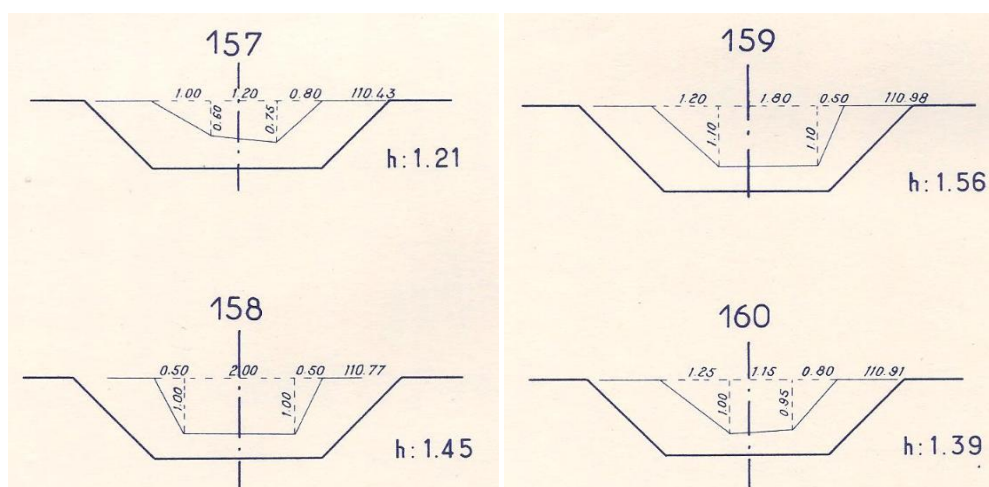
Extraits des plans de travaux de recalibrage du Suin en 1967 sur les communes de Rosnay et Douadic (Source : SIABVM)
